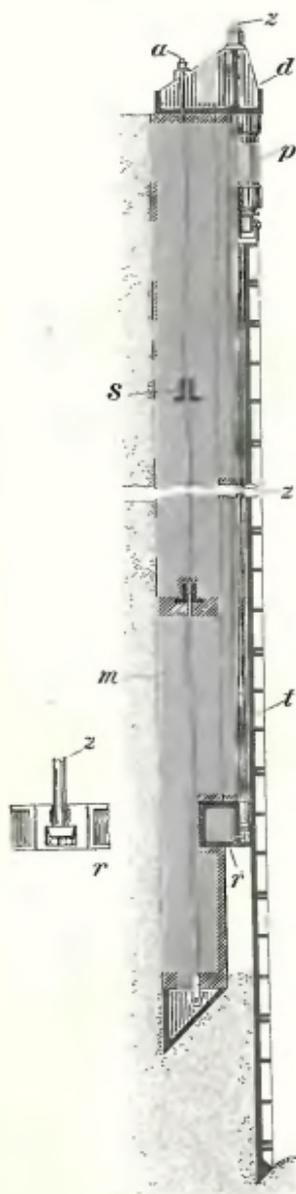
Drückring mit Ankerstangen und Ankerring.
